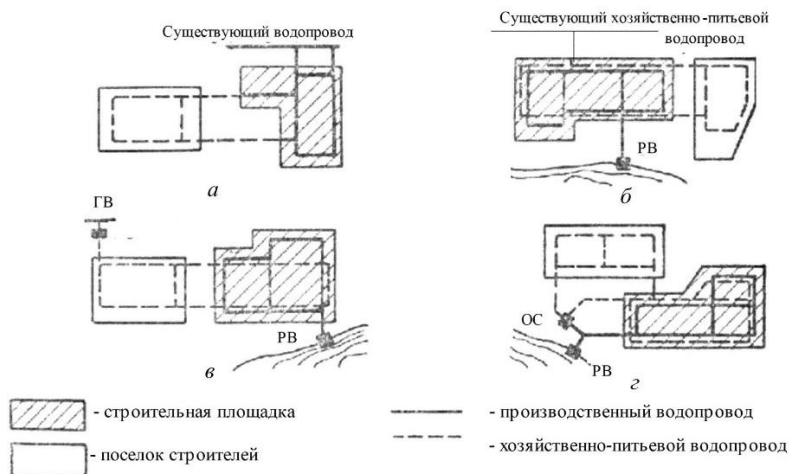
Источники и схемы водоснабжения строительной площадки: РВ – речной водозабор; ГВ – водозабор грунтовых вод; ОС – очистные сооружения
